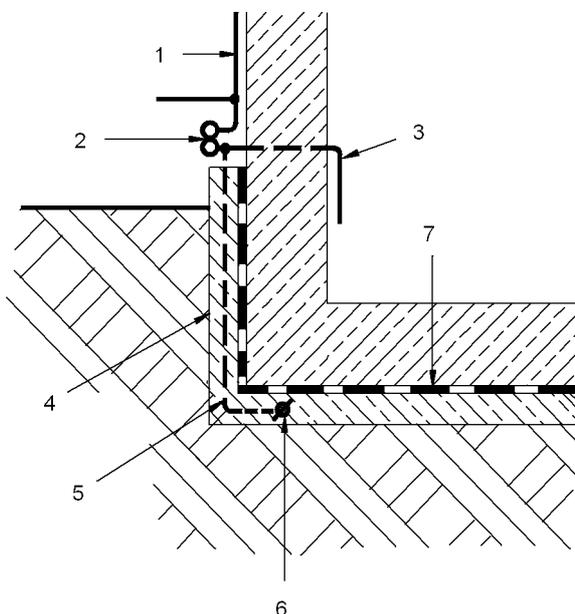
Isoliertes Fundament mit Fundamenterder in der Betonschicht ohne Bewehrung unter der Bitumenisolierung
